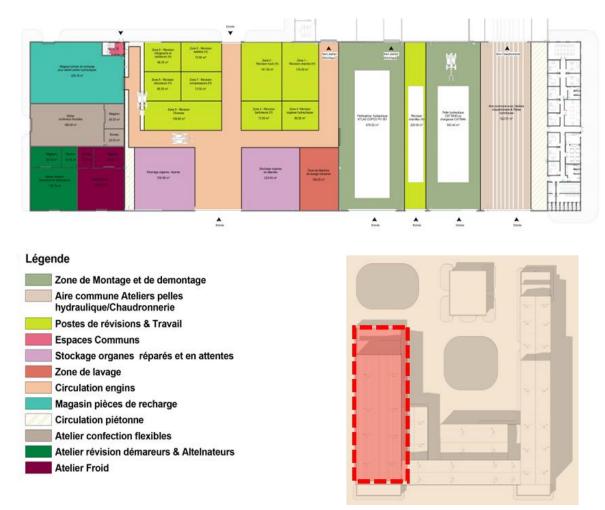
Atelier pelles hydrauliques : plans et détails d'organisation
